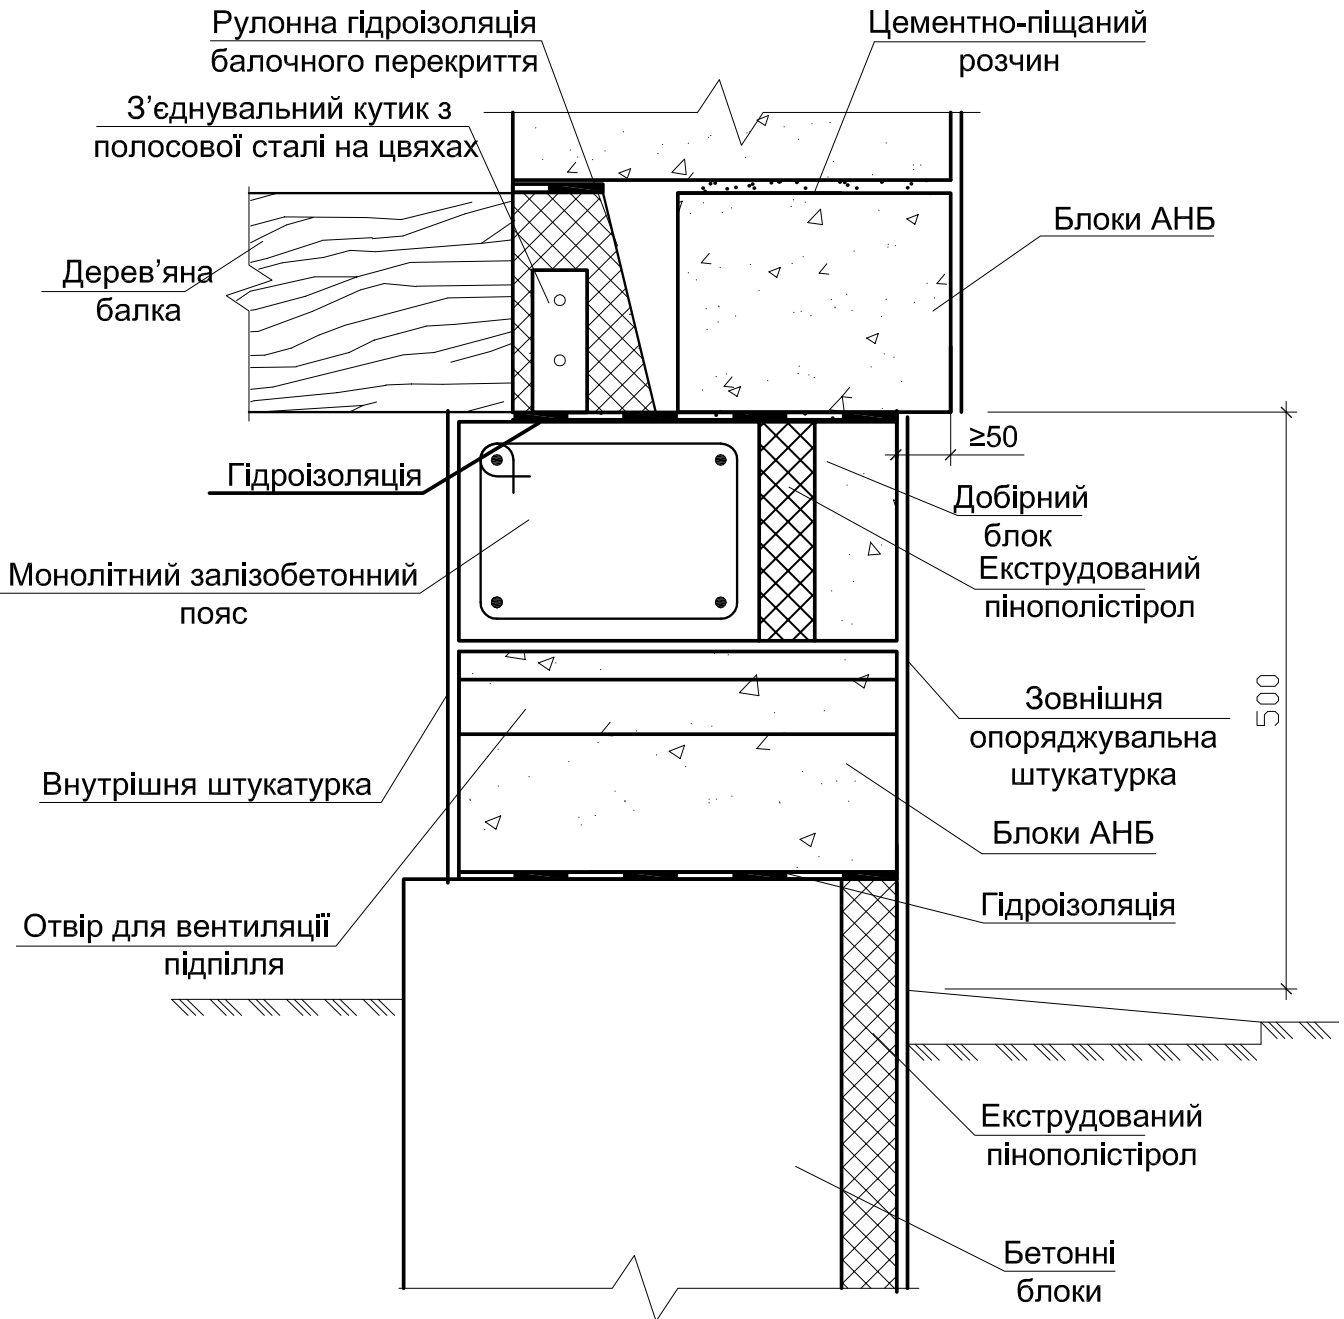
2-6. Спирання дерев'яного балочного перекриття на фундамент зовнішньої стіни
